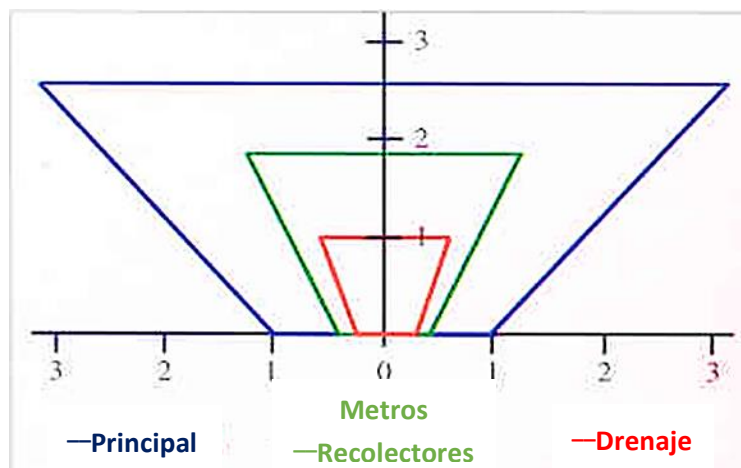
Tipo de drenaje recolector con balde trapezoidal, para una plantación de palma africana.
